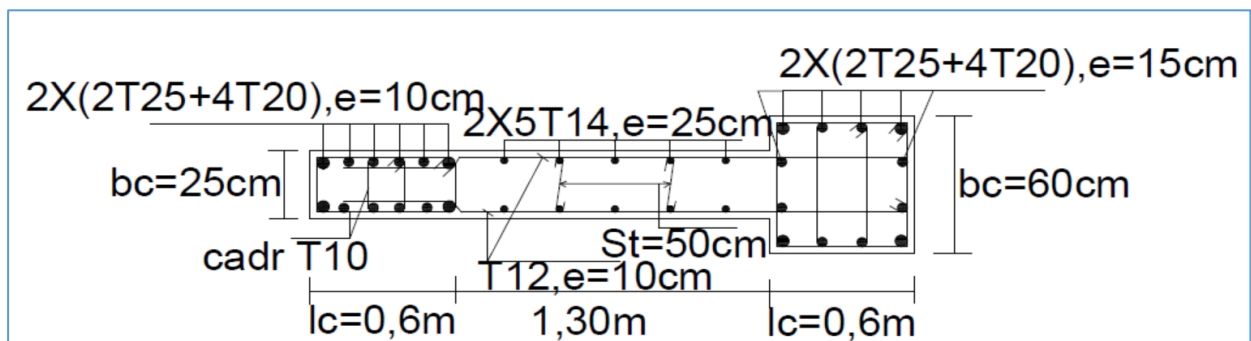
La coupe de ferrailage des voile sens x épaisseur 25cm.
